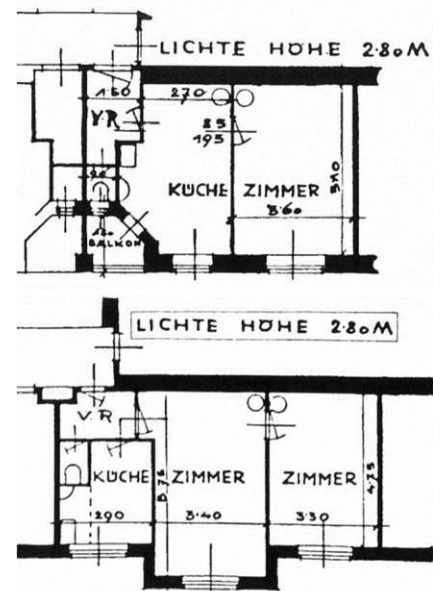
Beispielgrundriss einer Gemeindewohnung mit 38 m² (oben) und 48 m² (unten)
